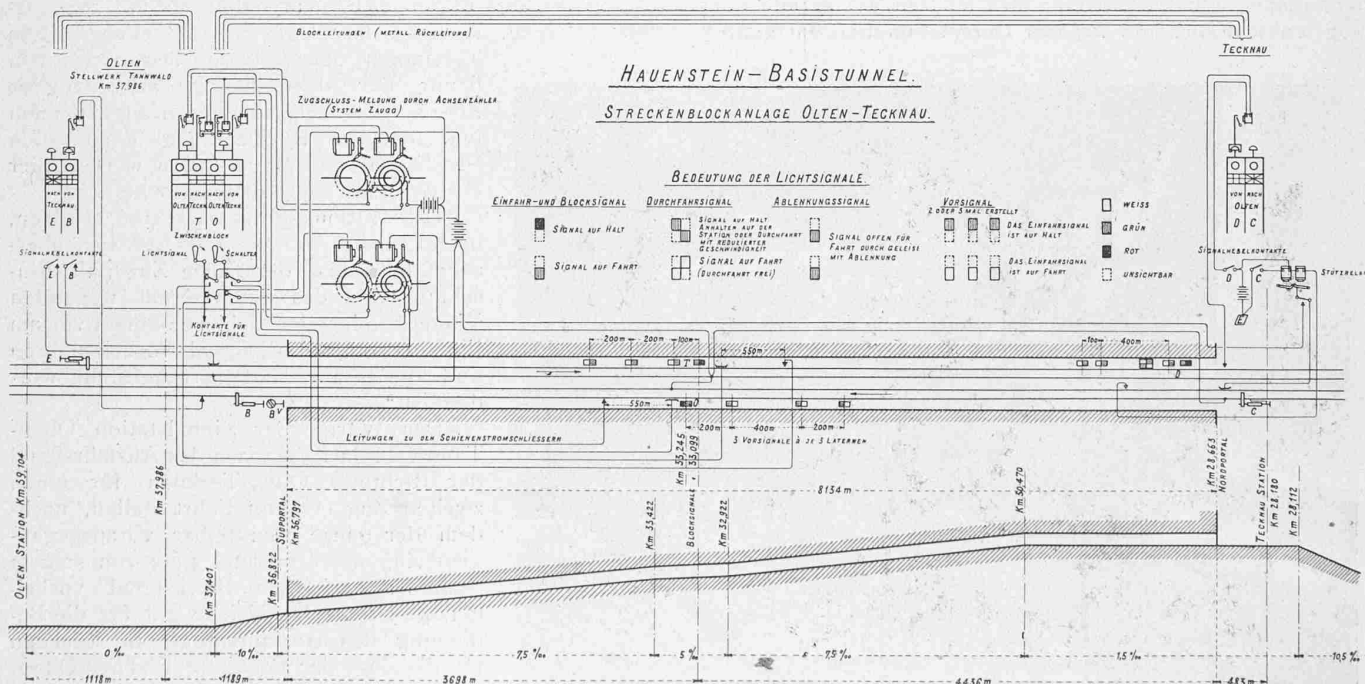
Längenprofil des Hauenstein-Basistunnel mit schematischer Darstellung der Streckenblockanlage Olten-Tecknau.
